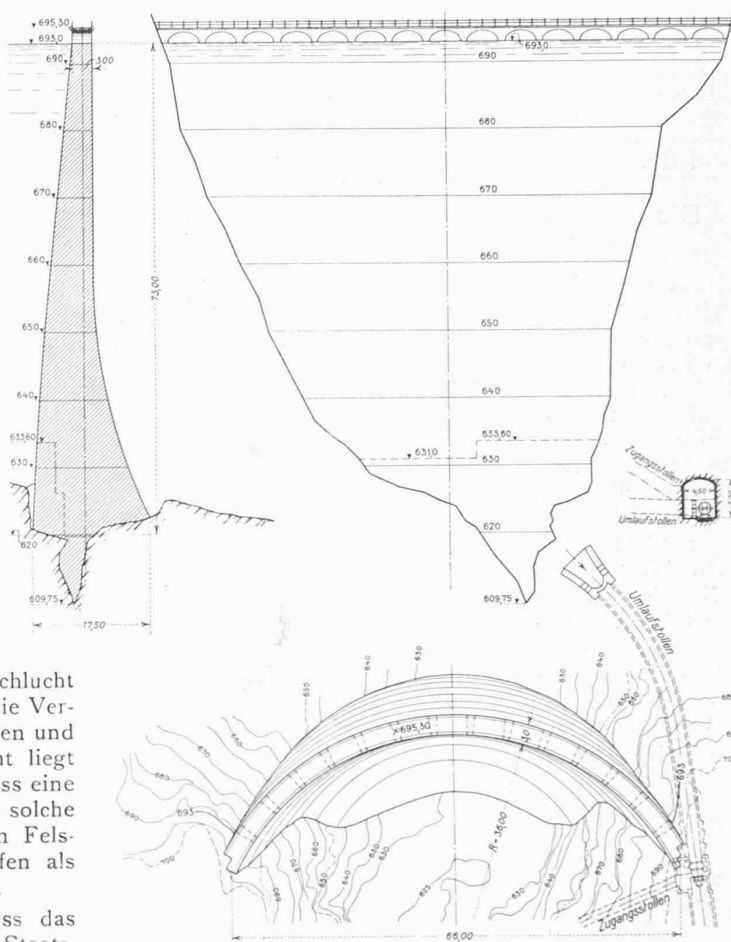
Draufsicht, luftseitige (abgewinkelte) Ansicht und Schnitt, 1:1000.
